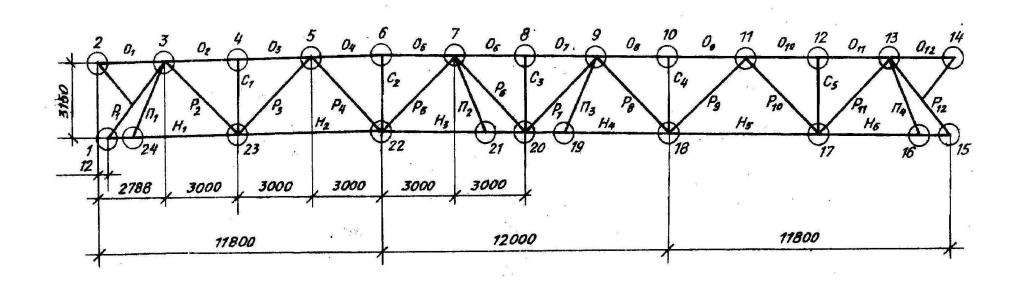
Геометрическая схема фермы V ФС 36 - 5, 55 B
